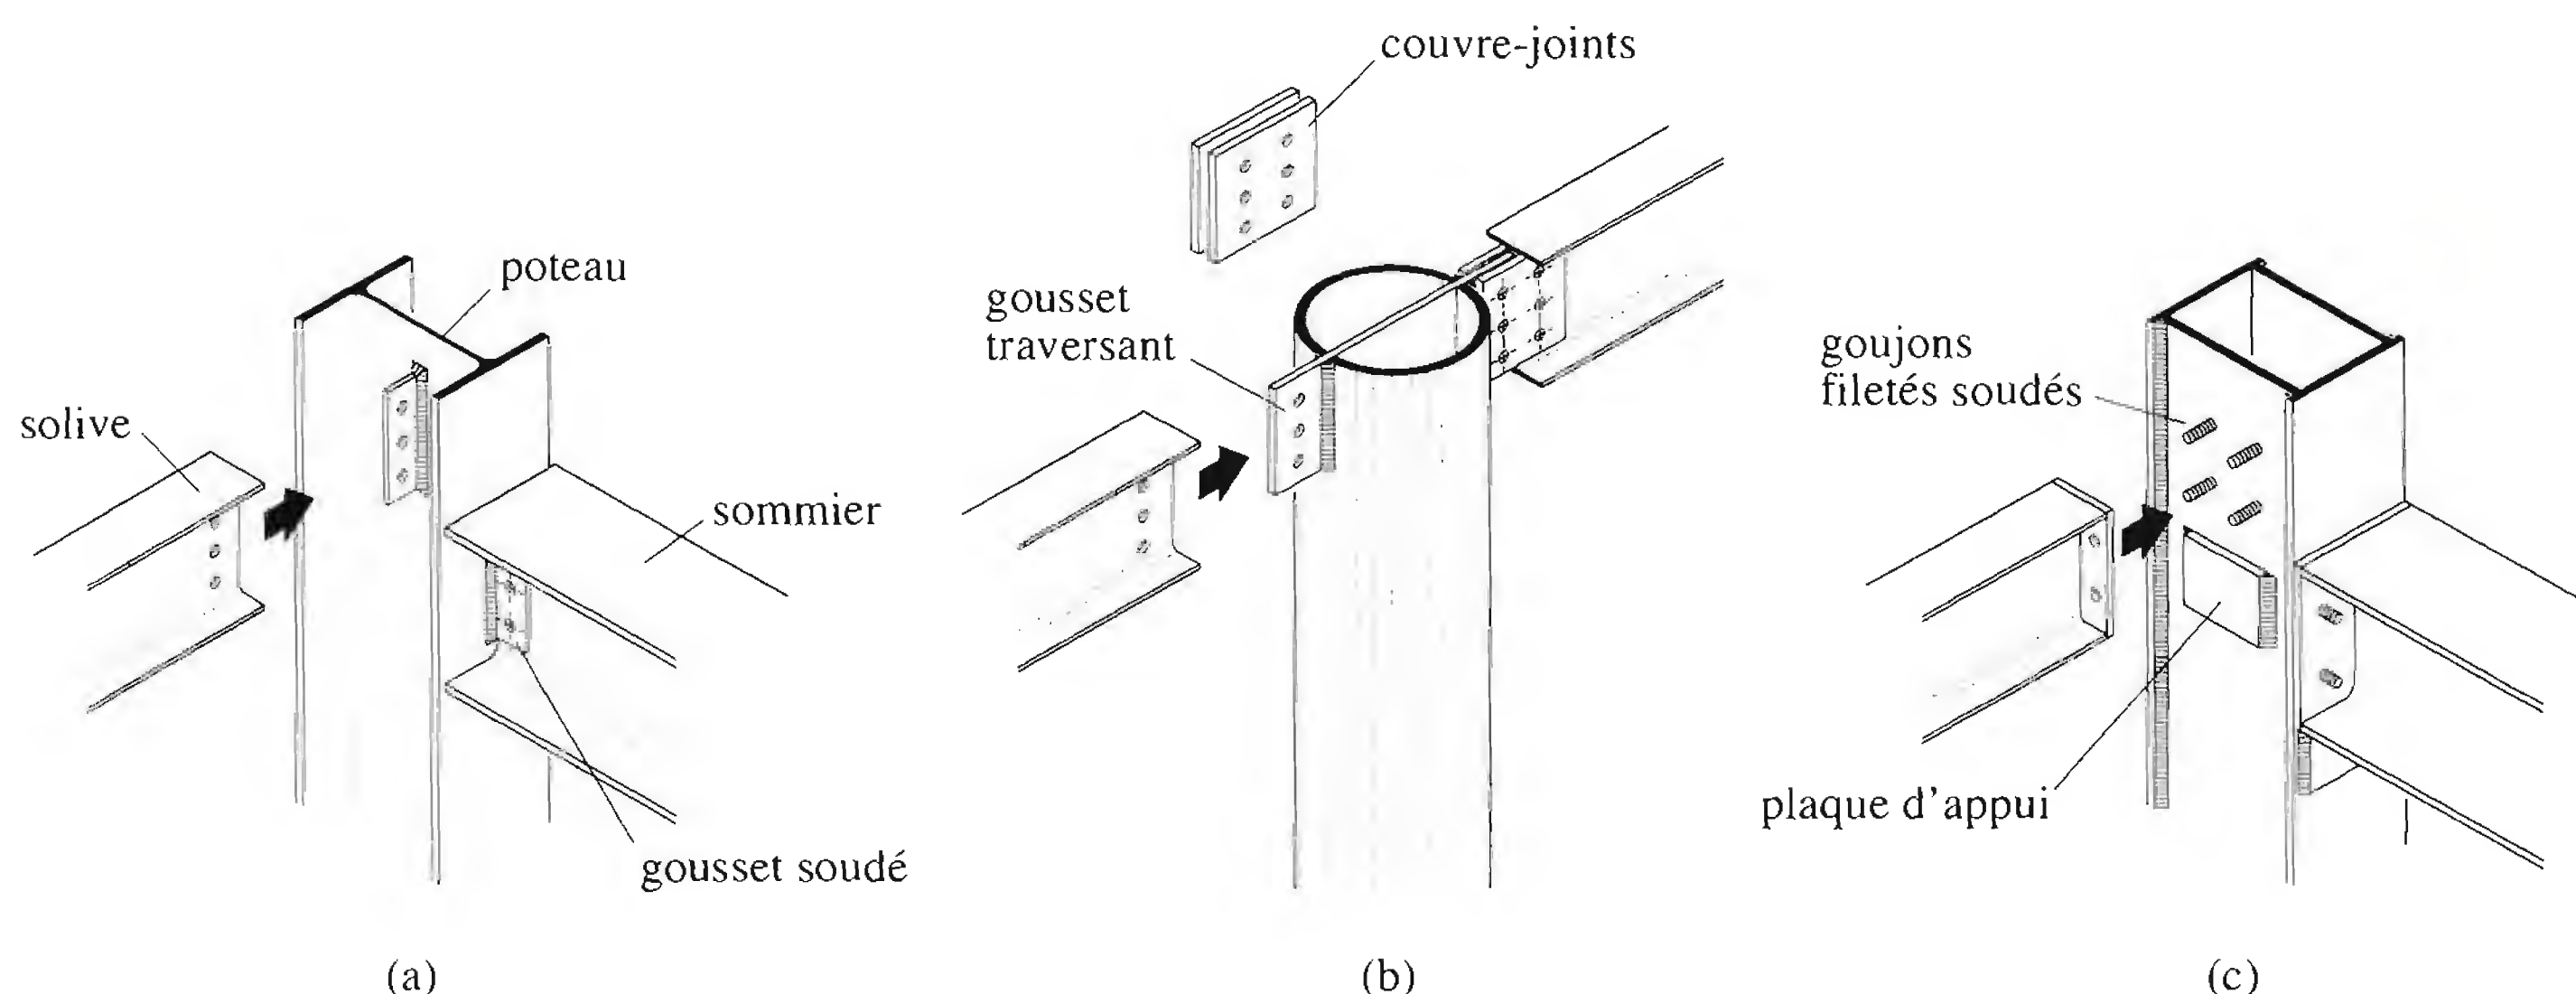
Assemblages articulés particuliers poutre-poteau.
